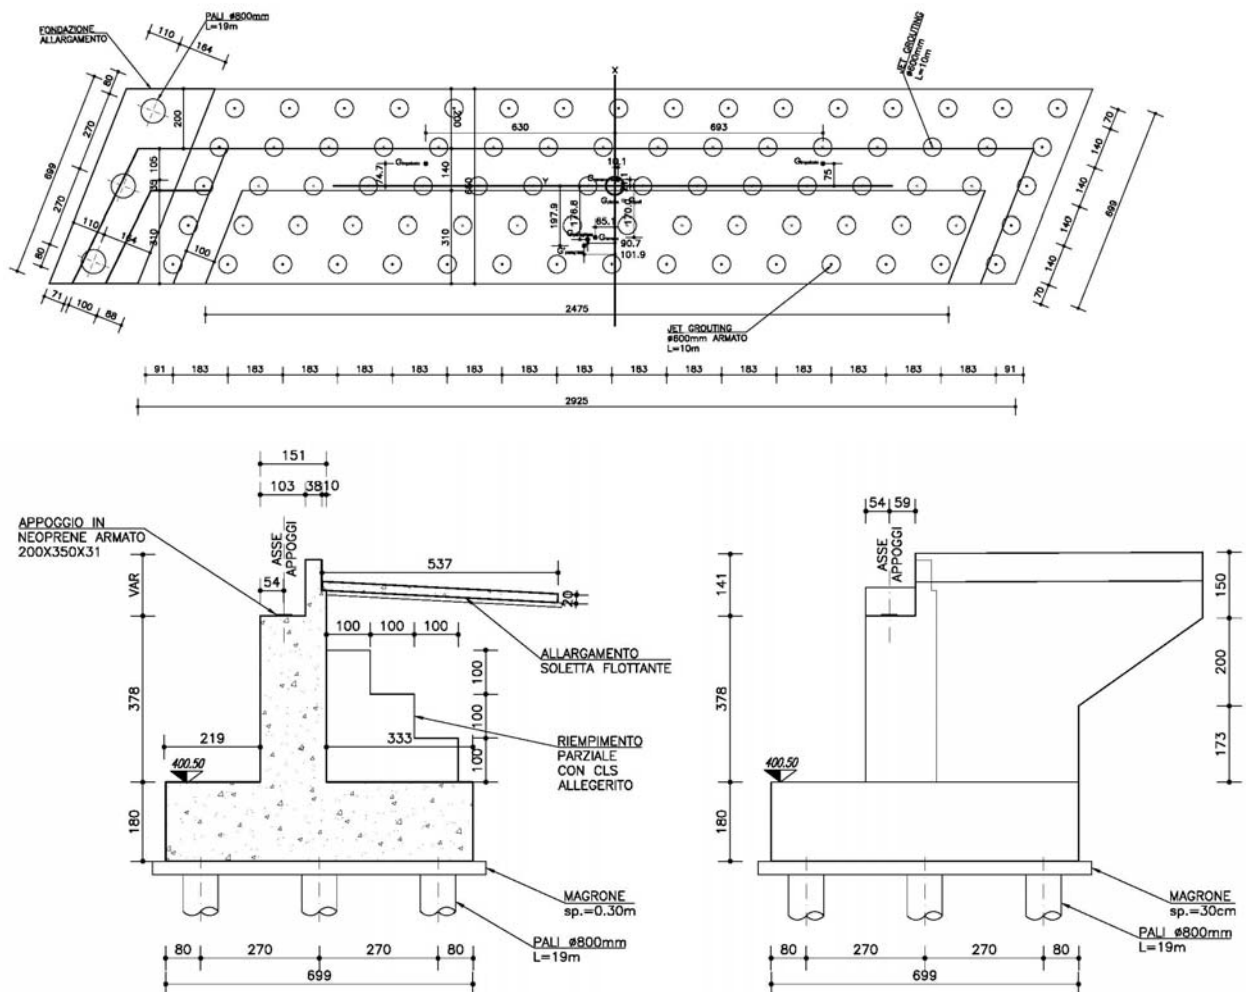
Geometria di calcolo della spalla lato Bardonecchia nello stato di progetto
